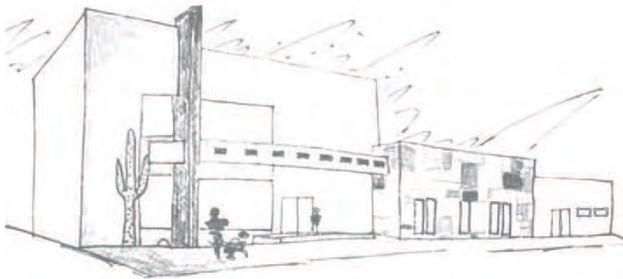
Primera propuesta de fachada principal. Fuente A.C.
